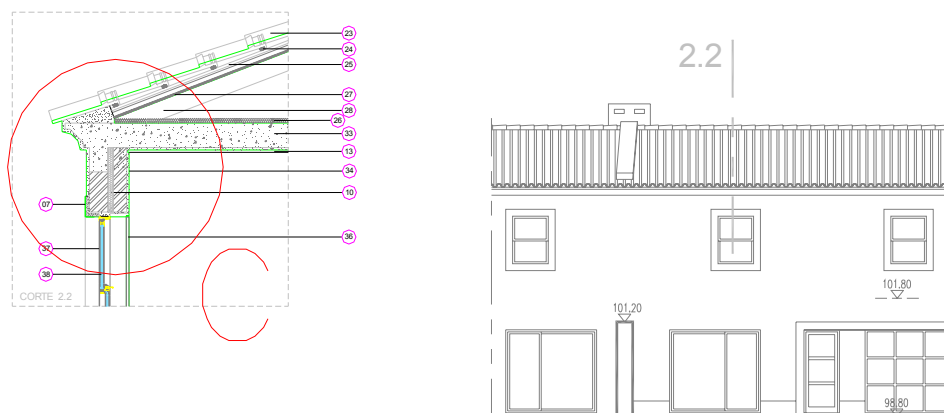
(cont.) – Corte construtivo pela fachada.
